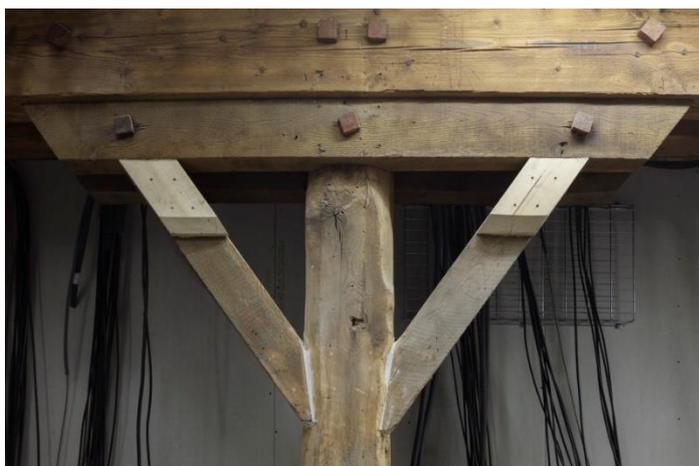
Assemblage existant composé de poteau en bois massif, poutre porteuse en résineux, sommier en chêne, contrefiches en chêne, boulon de serrage. © Schnepf Renou
